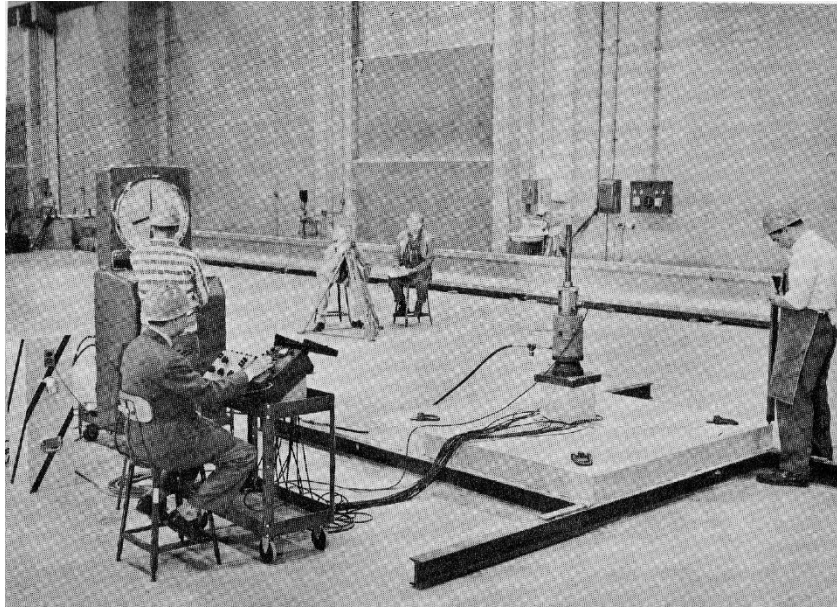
Sistema de ensaio (MOE, 1961)
